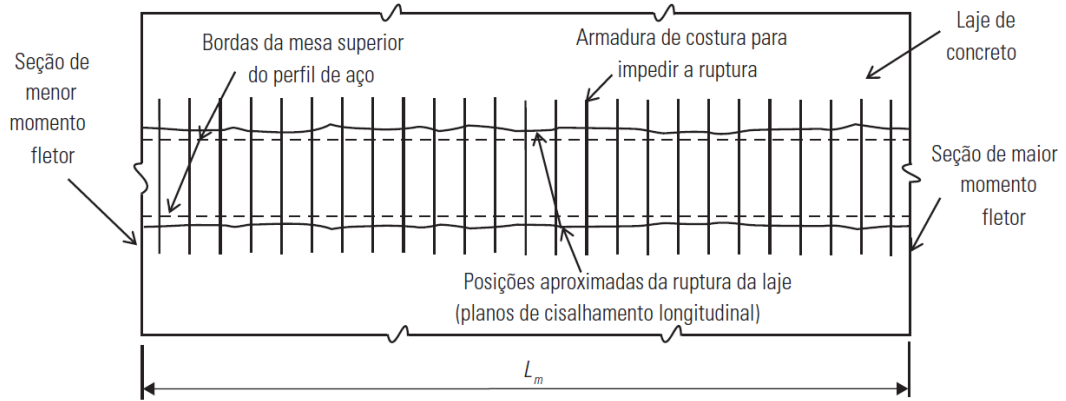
Posições de fissuração da laje e armadura de costura (Fonte: Fakury, 2016)
